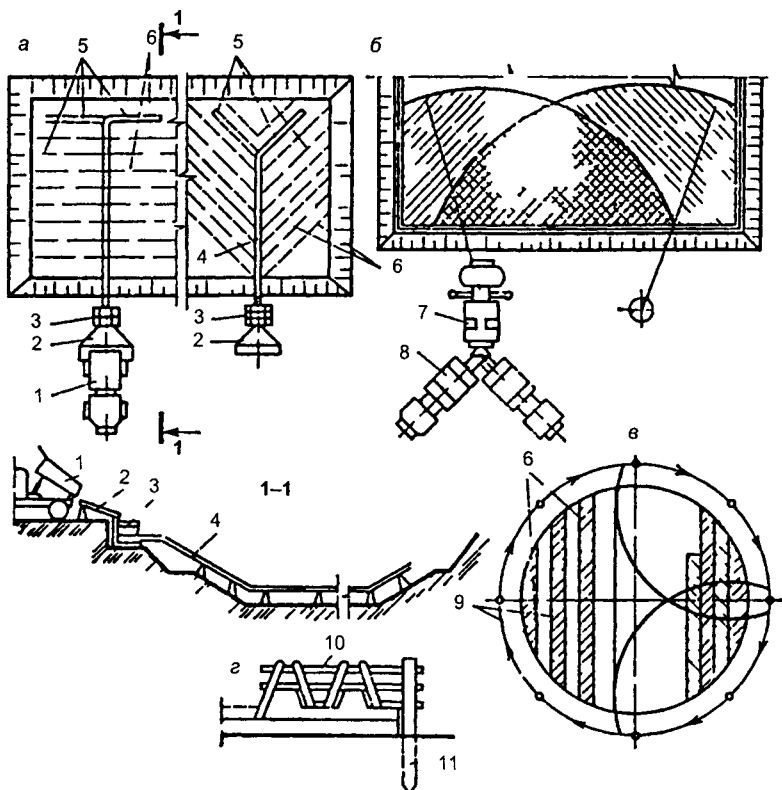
Схема укладки бетонной смеси бетононасосами и устройства опалубки днаща:
